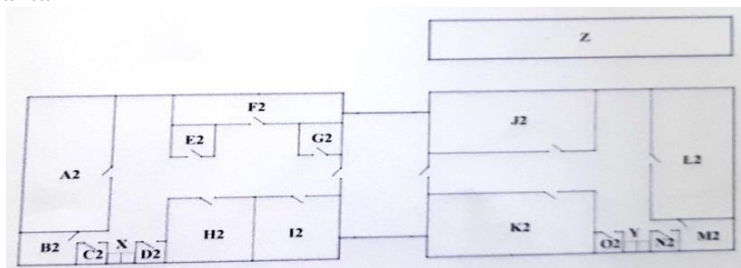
Denah Gedung Rektorat IAIN lantai 1
